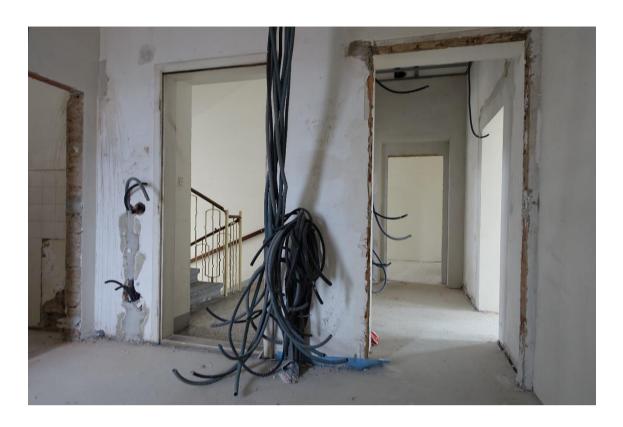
Vorraum mit Zwischengang ("Gard.")
